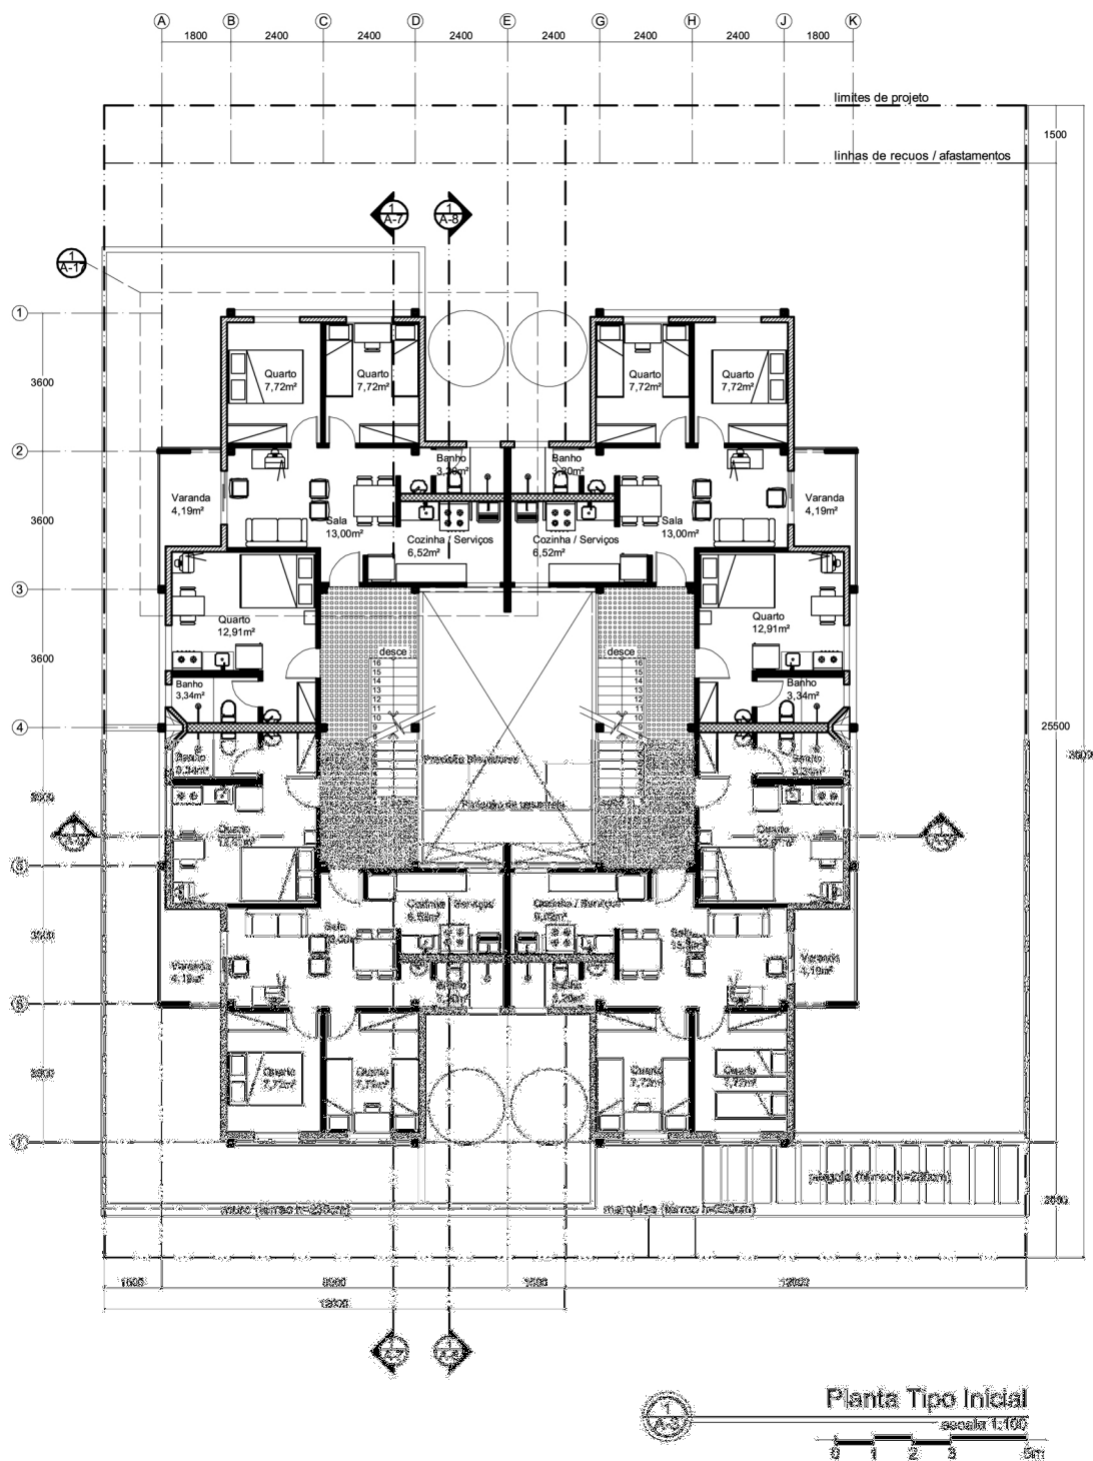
Planta pavimento tipo inicial. Fonte: Arquivo do autor
